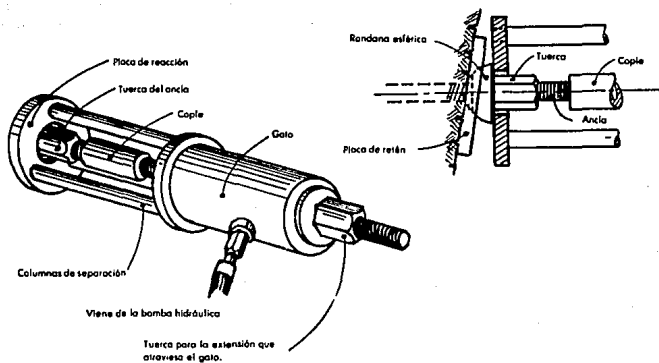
Instrumento hidráulico para el tensado de anclas.
